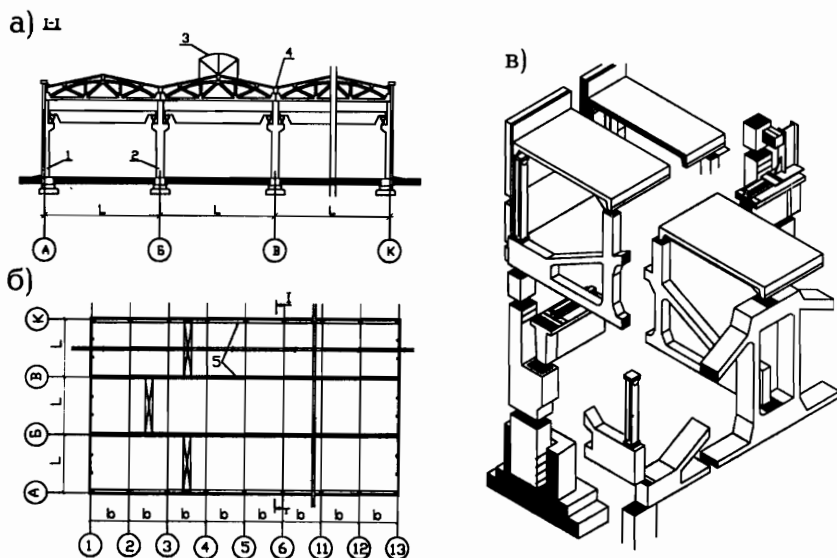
Конструктивно-технологическая схема одноэтажного промздания с железобетонным каркасом: а - разрез; б - план; в - узлы и сопряжения; 1, 2 - колонны крайняя и средняя; 3 - фонарь; 4 - внутренний водосток; 5 - оси крановых путей
